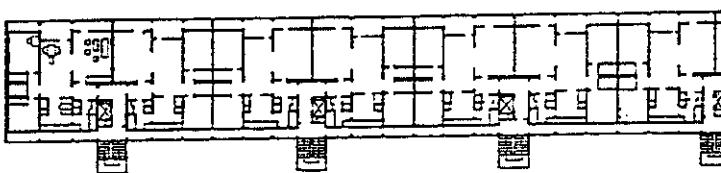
Chung cư kiểu hành lang bên và các kiểu bố trí khu phụ
